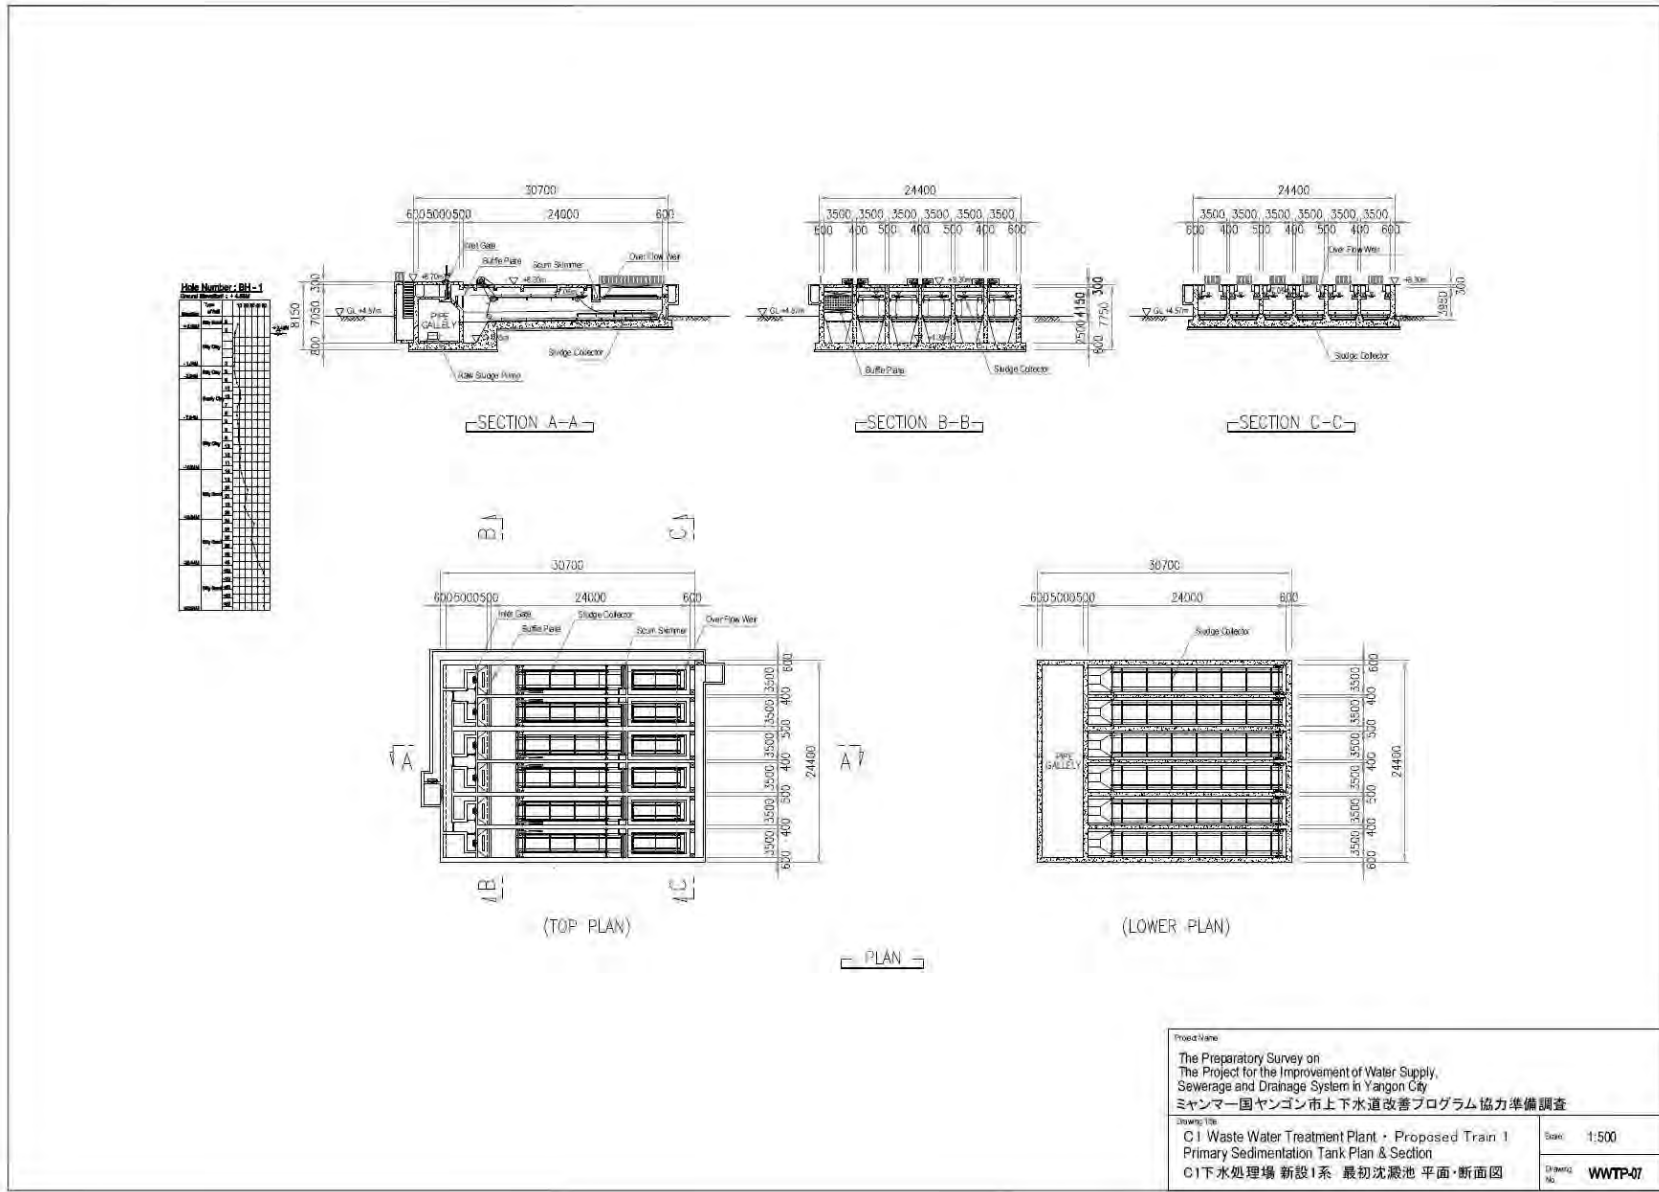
最初沈殿池 平面図・断面図 (既設系-新設)
